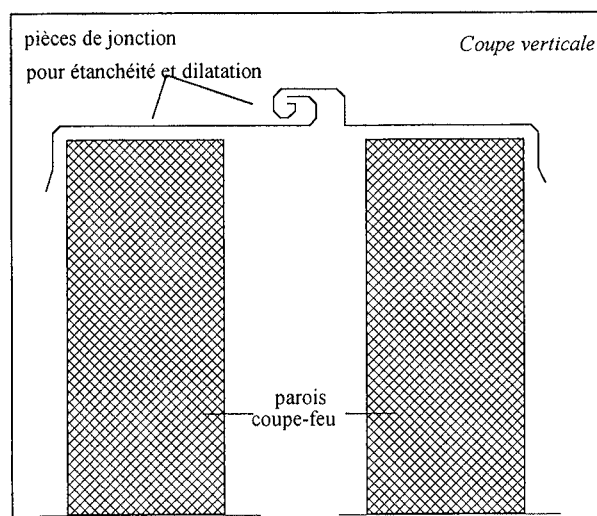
Etanchéité entre les 2 parois d'un MSCF double
